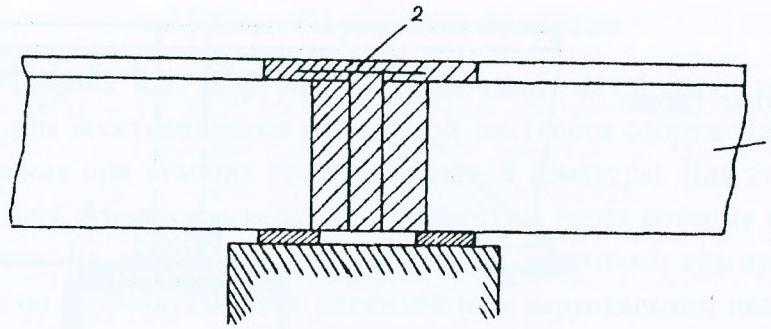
Усиление балок омоноличиванием опорных узлов: 1 – балка; 2 – бетон омоноличивания.
